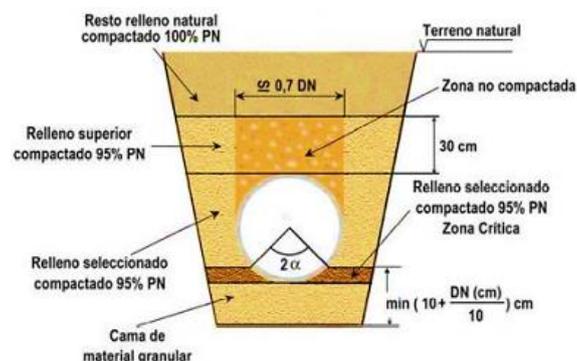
Detalle de la zanja de las tuberías de conducción de la instalación de riego. Fuente: <https://www.aristegui.info/caracteristicas-de-las-zanjas-para-tuberias-plasticas-enterradas/>.
